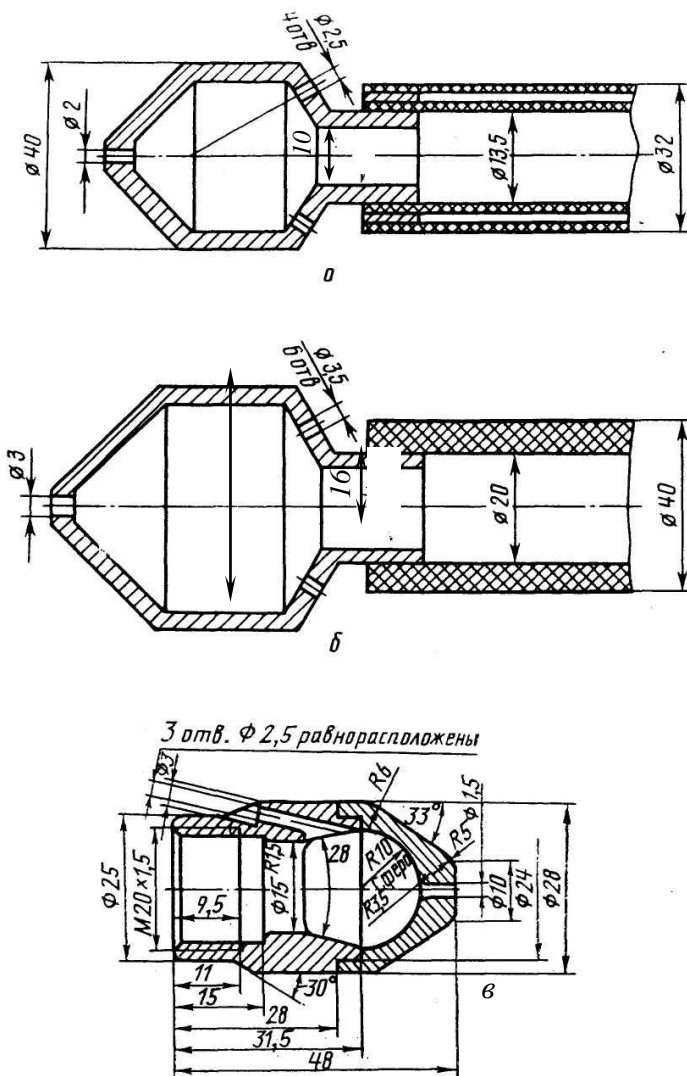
Конструктивные размеры головок: а – с двухслойным шлангом; б – для промывания коллекторов; в – для промывания дрен.
